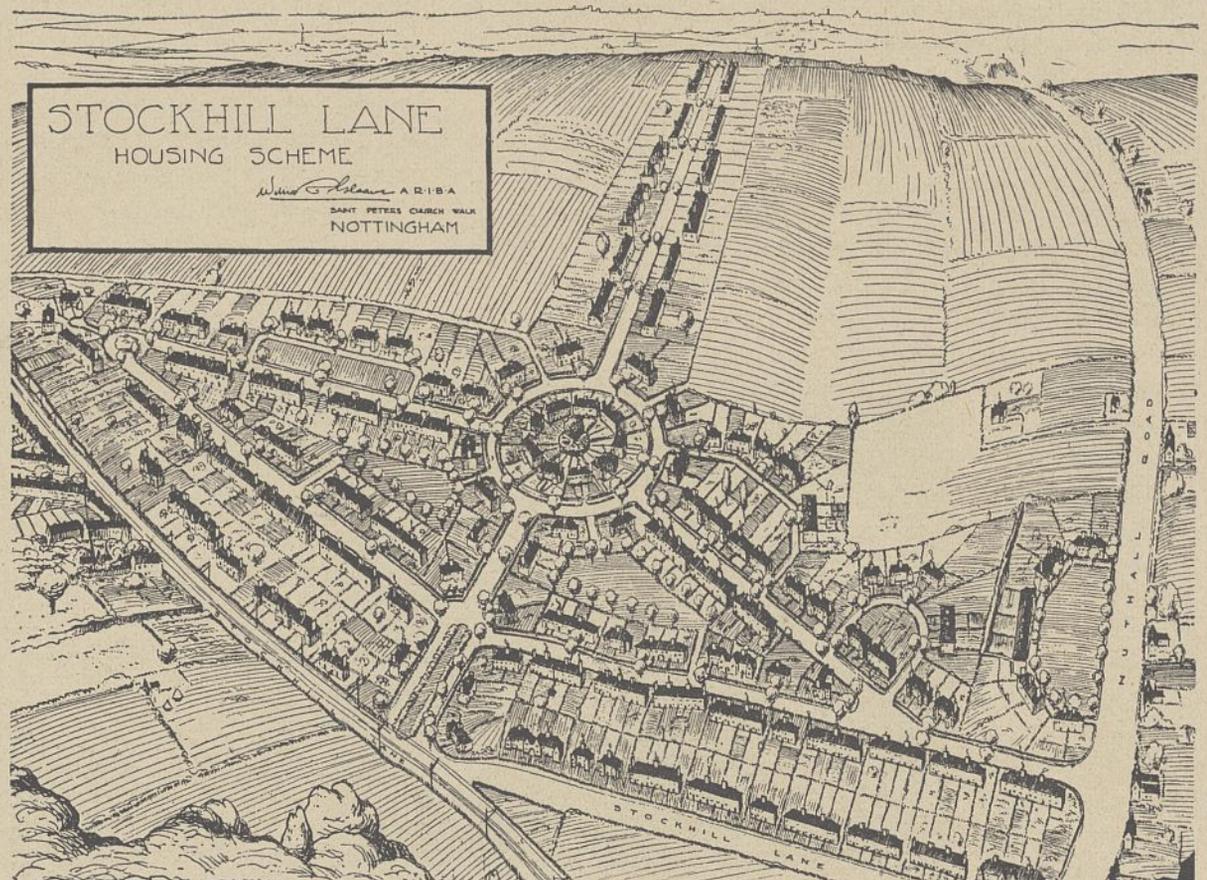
Bebauungsplan für Nottingham (Stockhill Lane).
